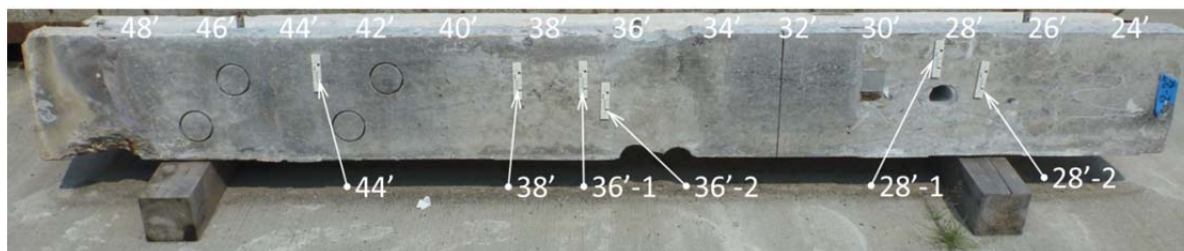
ひび割れゲージ設置状況（平成25年8月8日）
